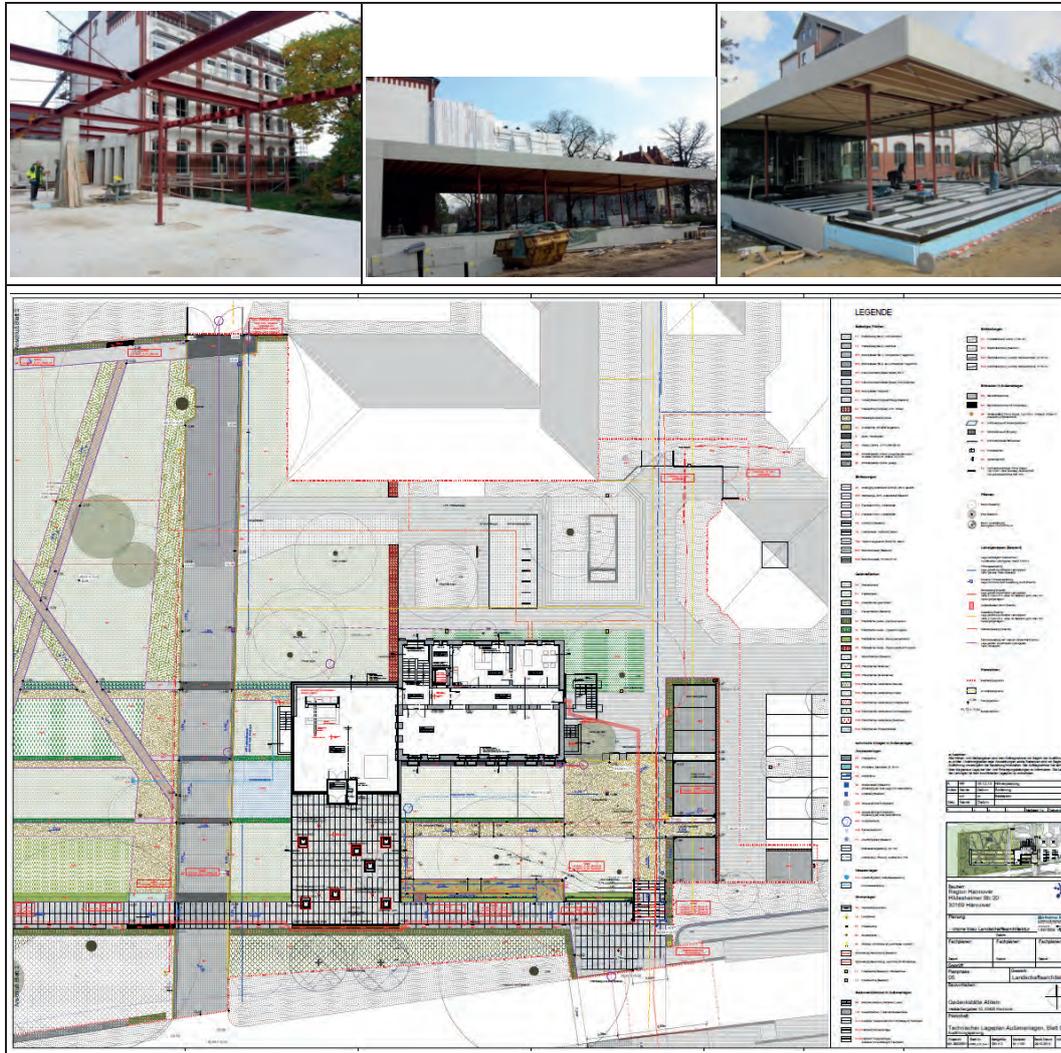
Ansichten und Lageplan Gedenkstätte Ahlem
